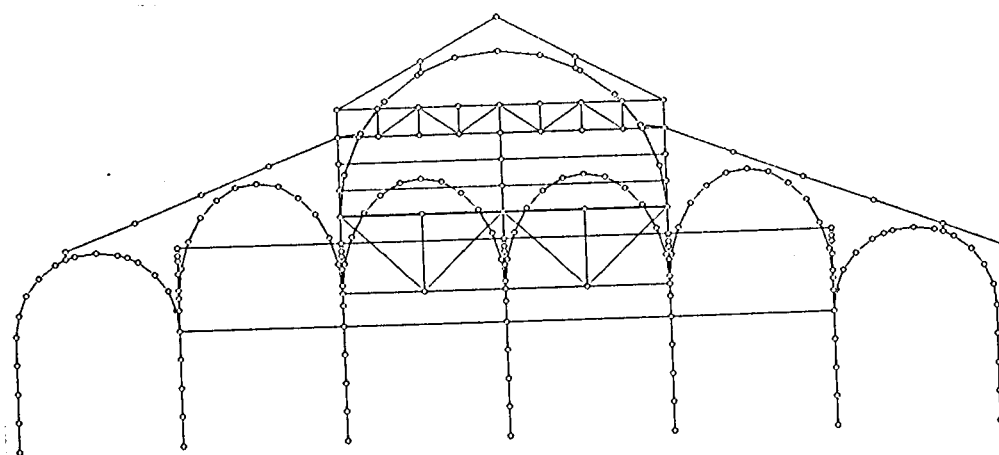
Shopgal. Modelação estrutural: alçado transversal.
